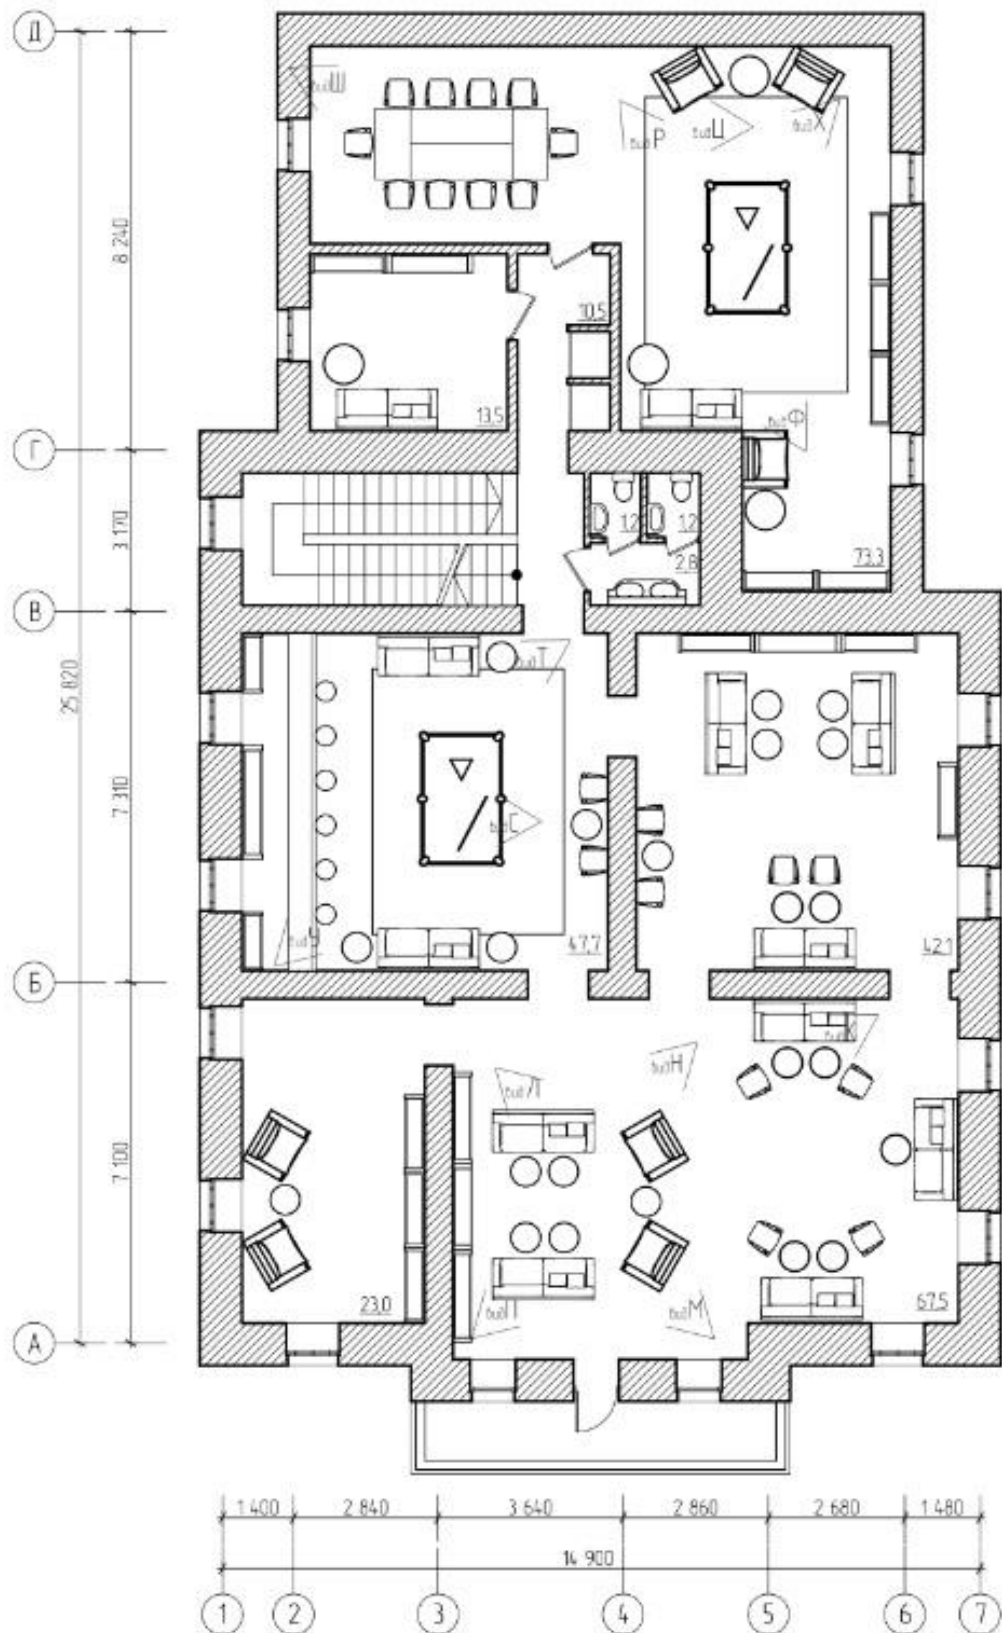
План 2 этажа с расстановкой оборудования
